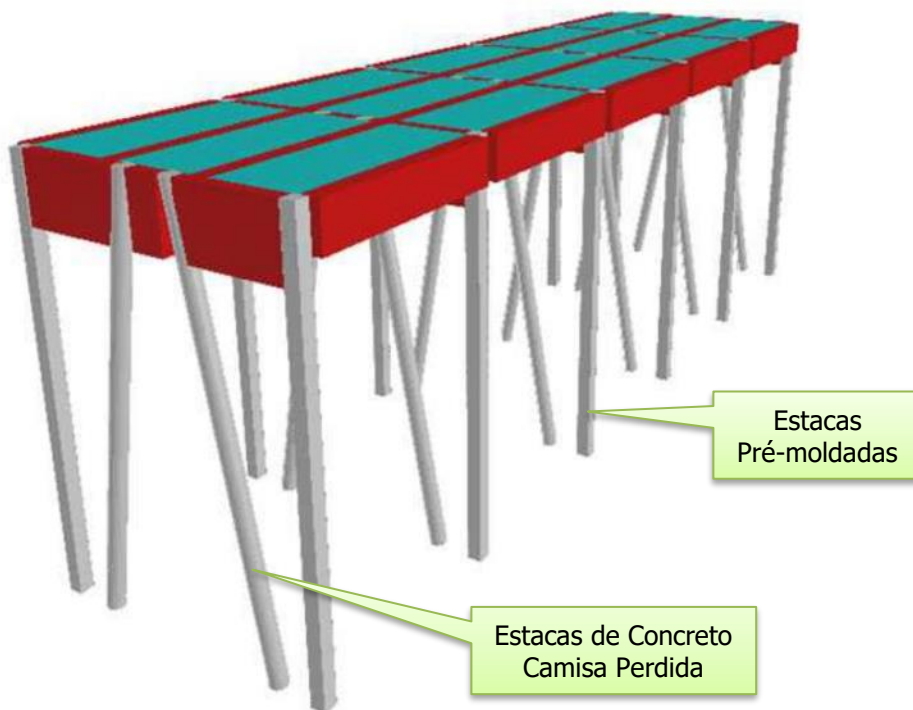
Vista Isométrica Típica das Estruturas dos Travessias
